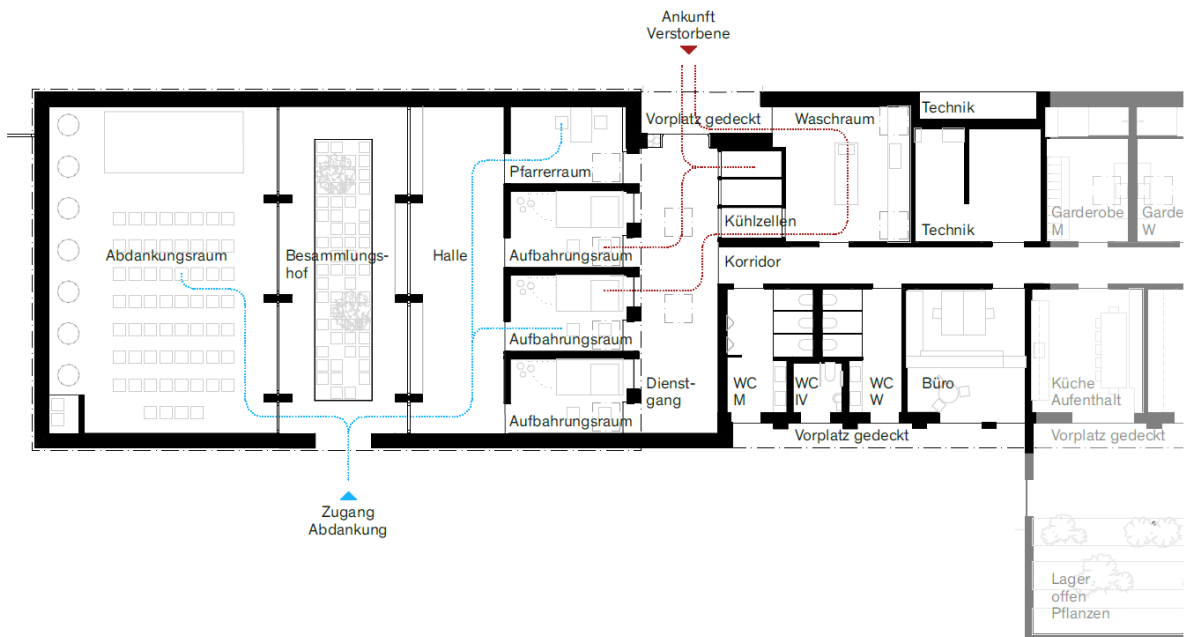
Grundriss mit Raumabfolge, sakraler Gebäudeteil
